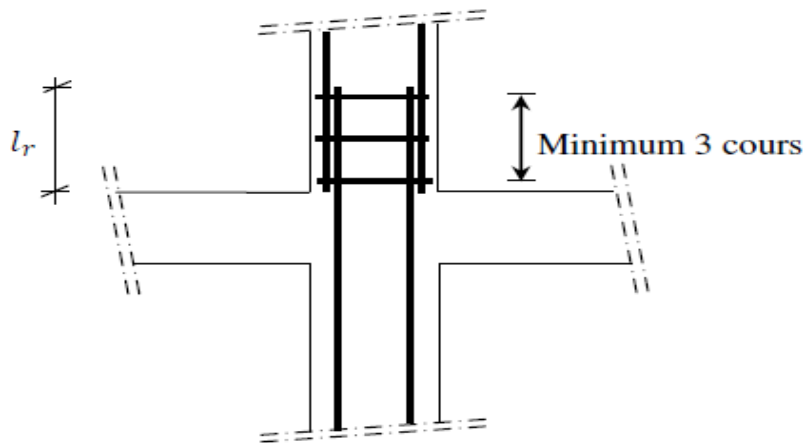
Les armatures transversales dans la zone de recouvrement.
